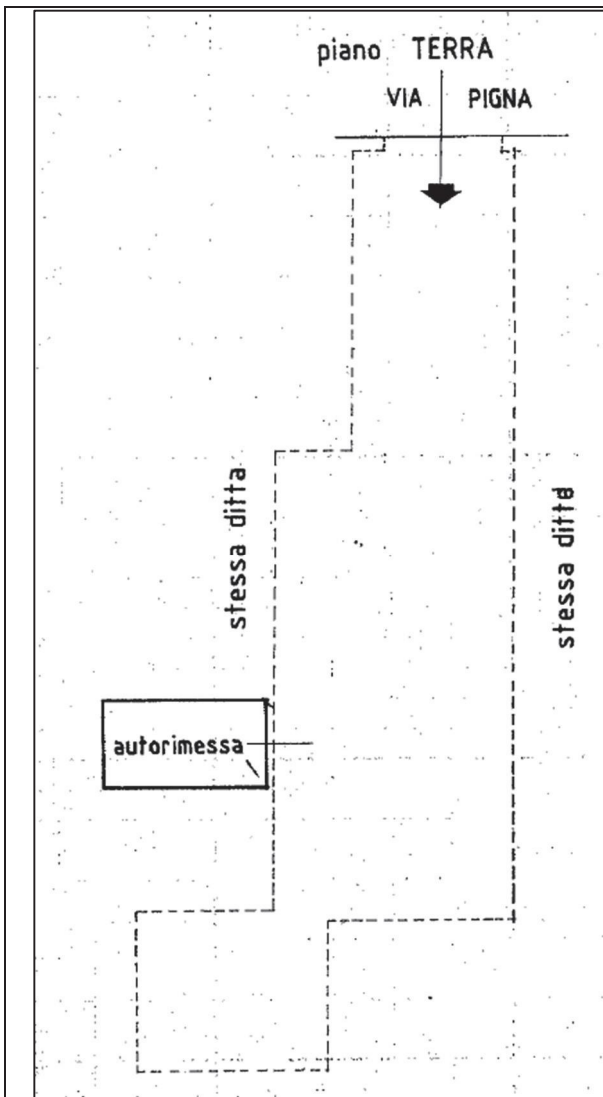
planimetria catastale dell'autorimessa identificata con la particella 98 sub 24
